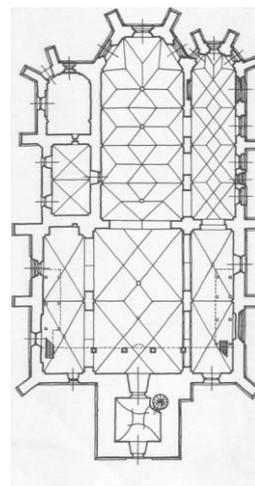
Štítník, evangelische Kirche, Grundriss, ab 1335
